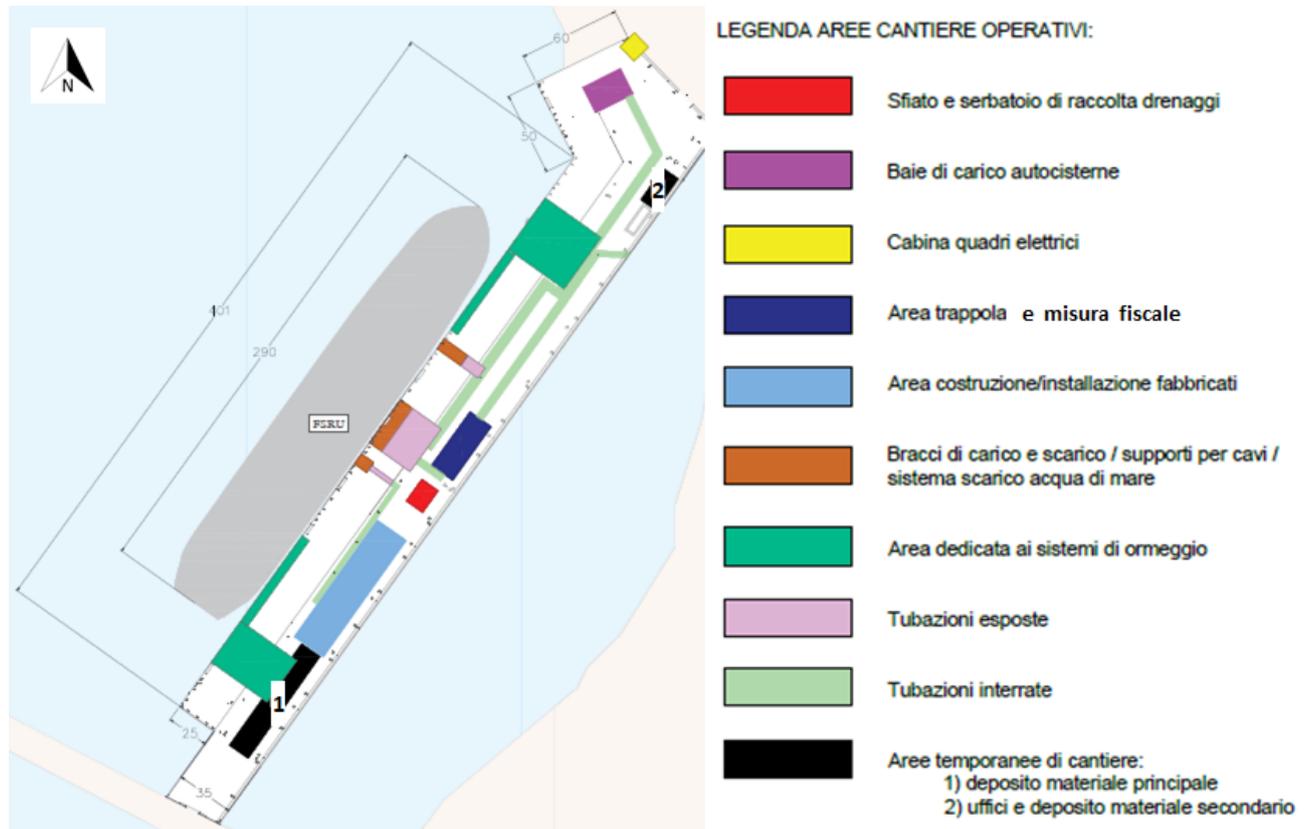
Planimetria Generale Aree Cantieri Operativi
